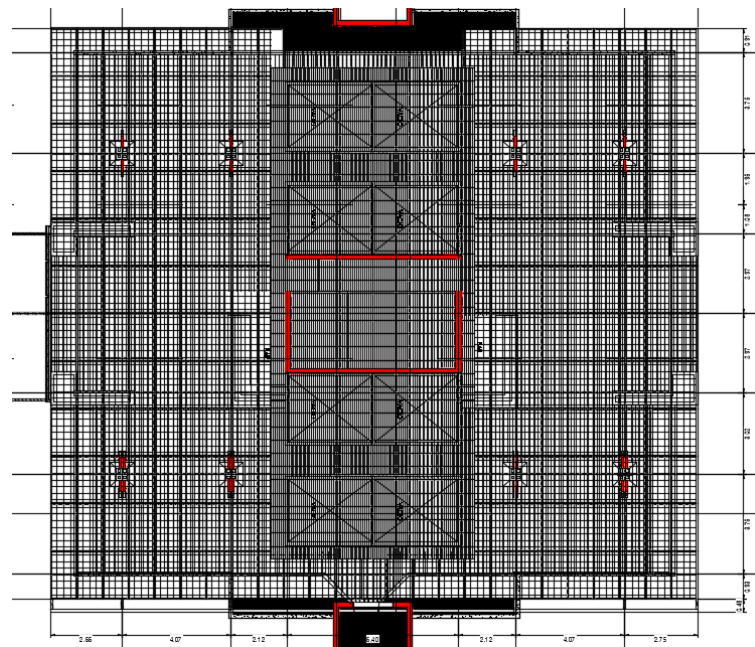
Planta de Techos analizada. Fuente: Elaboración propia
